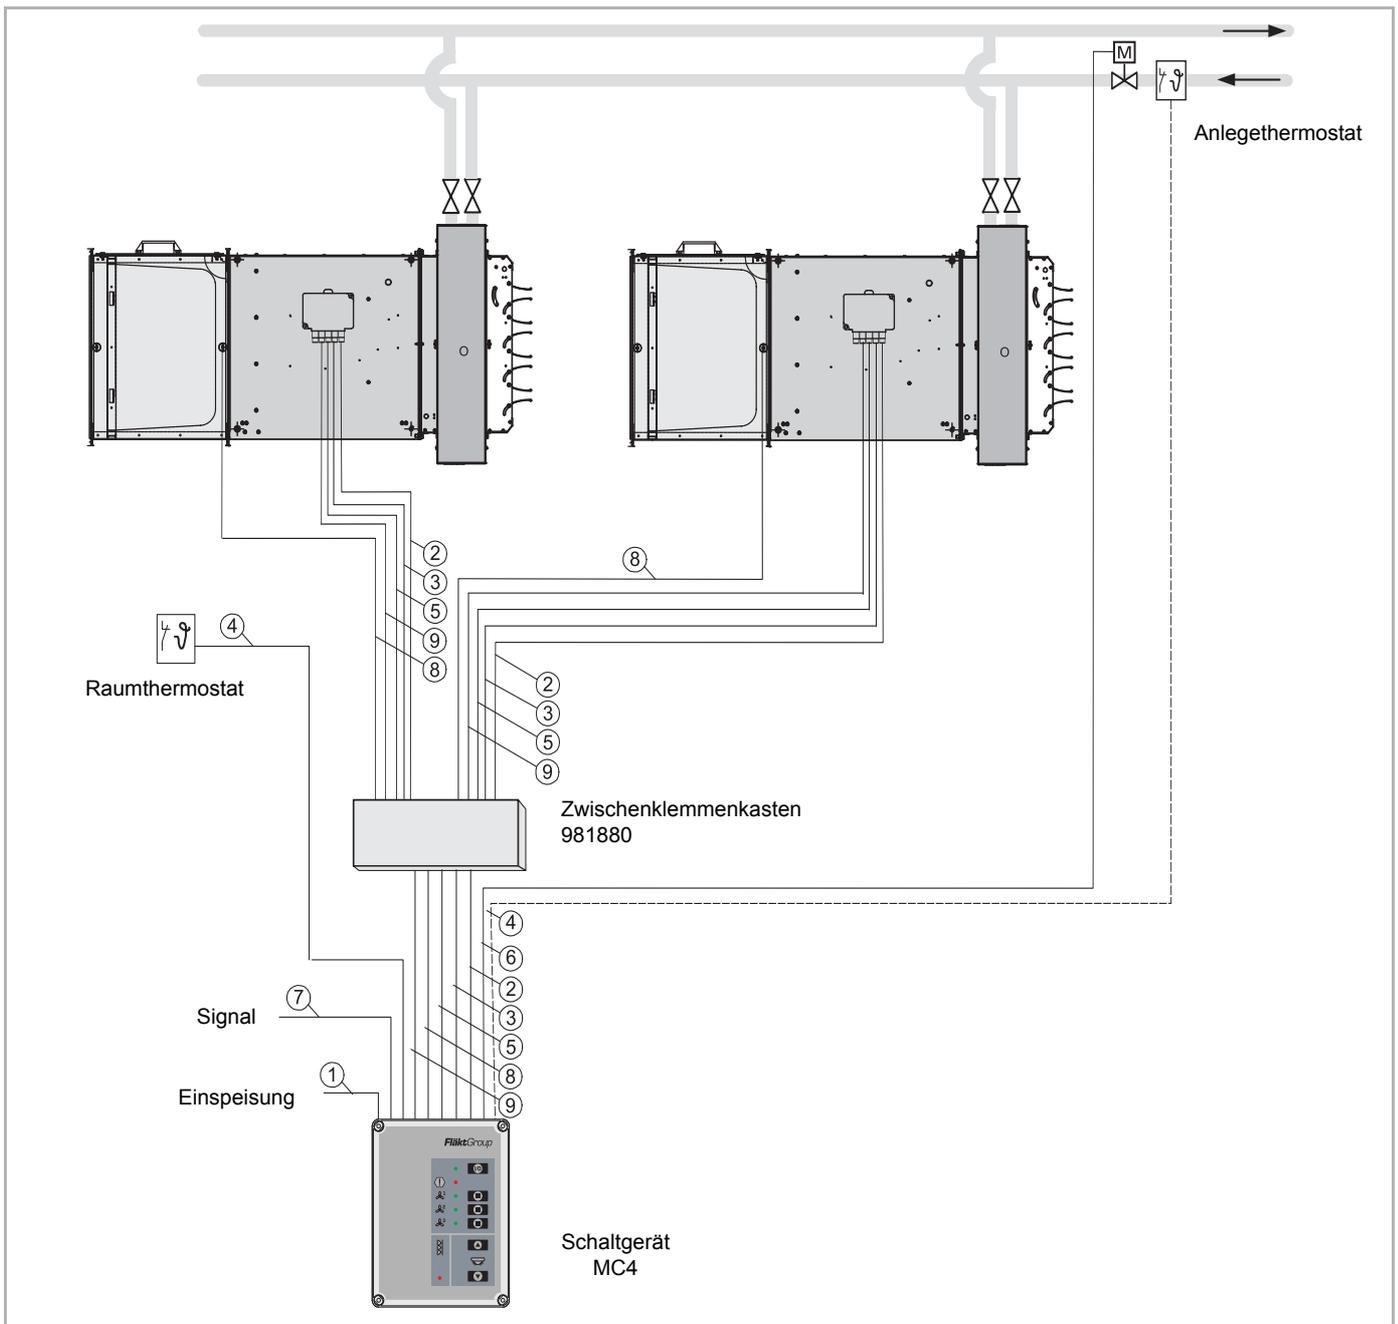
Gerätegruppe bestehend aus Mischluftgeräten MultiMAXX HN mit Schaltgerät MC4
